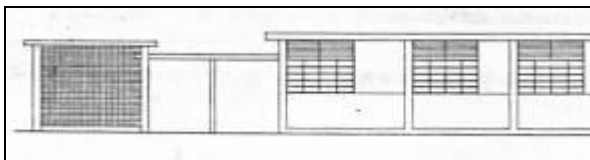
h. Vivienda PC-3. Fachada (1952)
